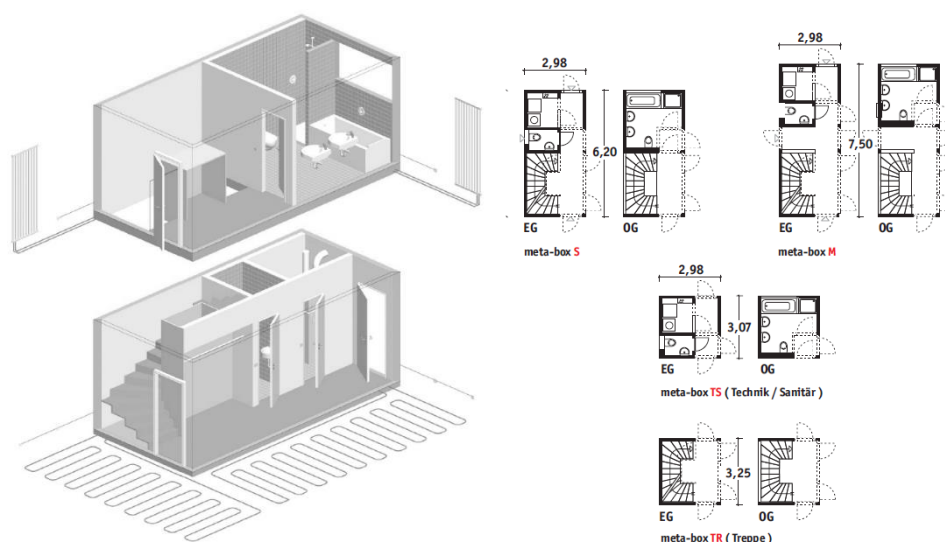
Construção com módulos parciais de casa de banho e de escada (<http://www.meta-box.de/flash6.htm>).
